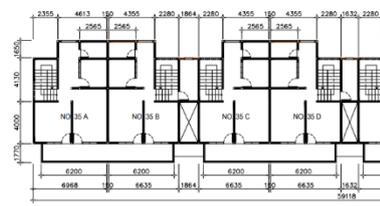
Denah eksisting area revitalisasi fase 1 dan 2. (Sumber: Arcadia Architects, 2019)
